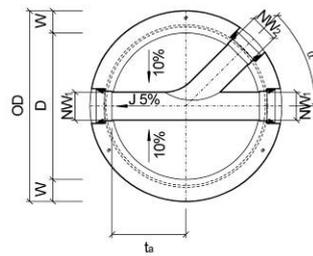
Grundriss CRENO Normschachtboden Typ 6
